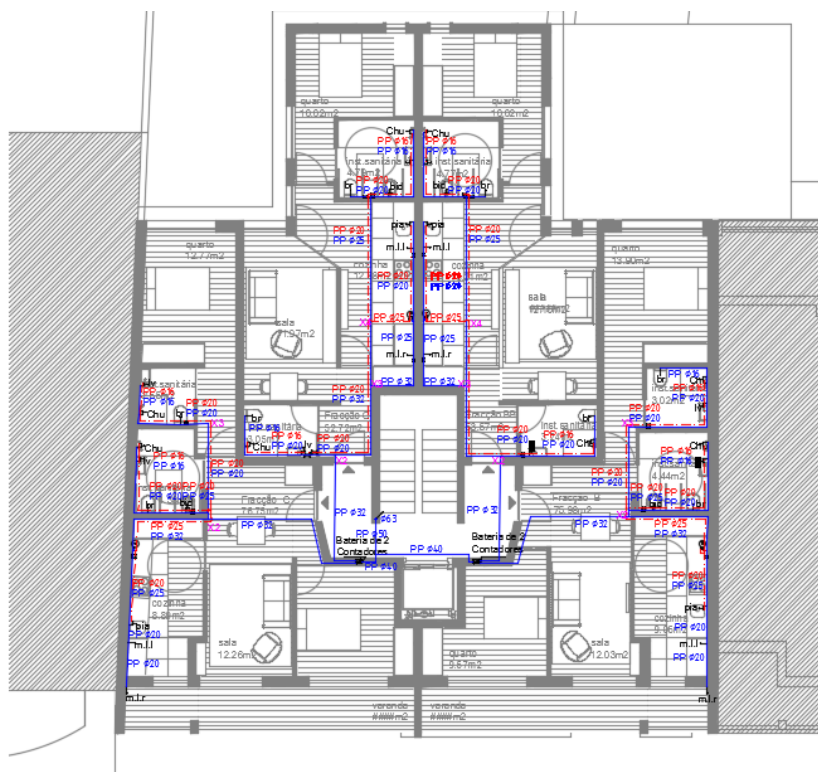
Traçado da rede de abastecimento de água do primeiro piso.
